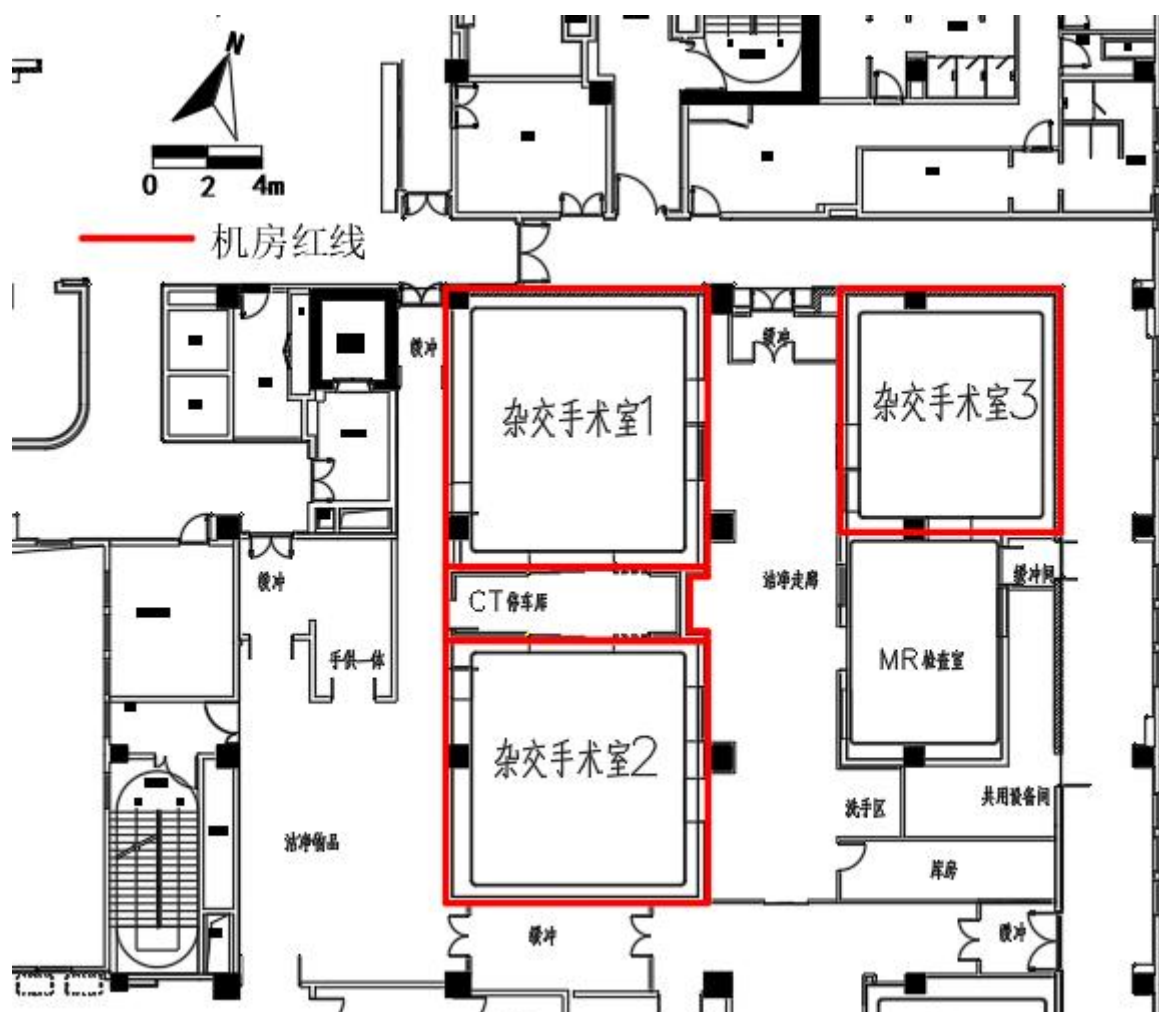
本项目杂交手术室 1、2、3 所在楼层（三层）局部平面布置示意图
